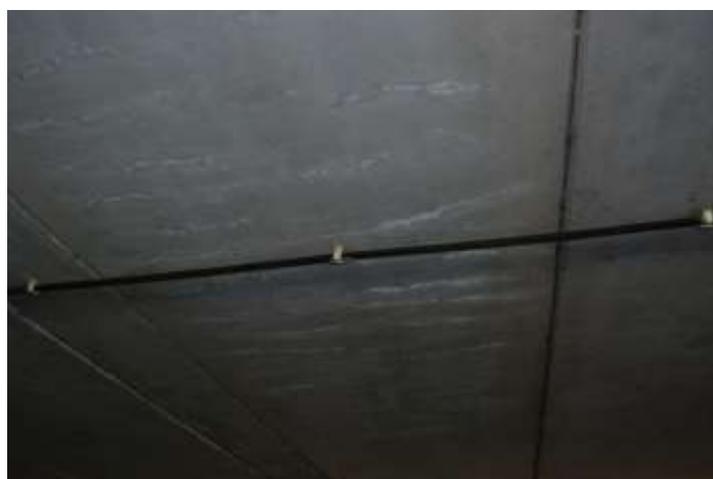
Laje fissurada e com eflorescência no sentido transversal
